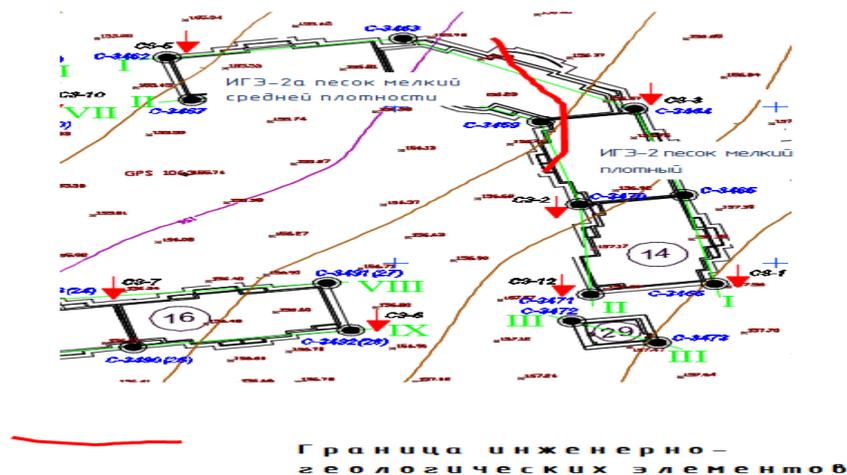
Границы различных грунтов под подошвой фундаментной плиты
